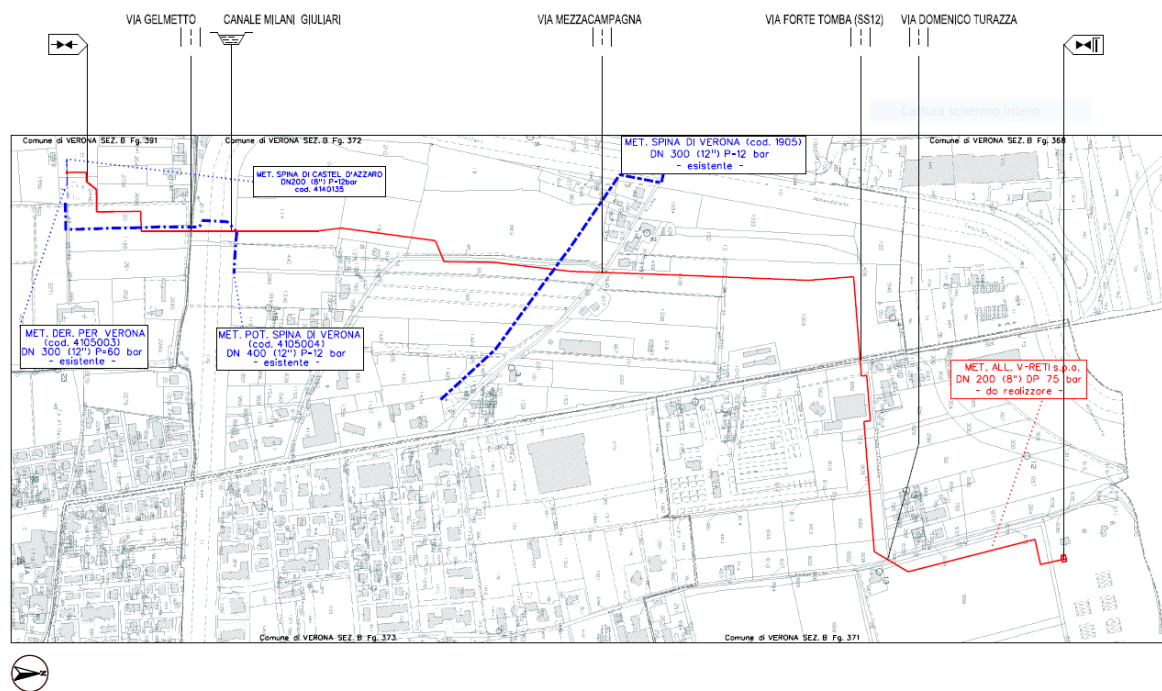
Ubicazione dell'area. Stralcio planimetria catastale. 1:5000
